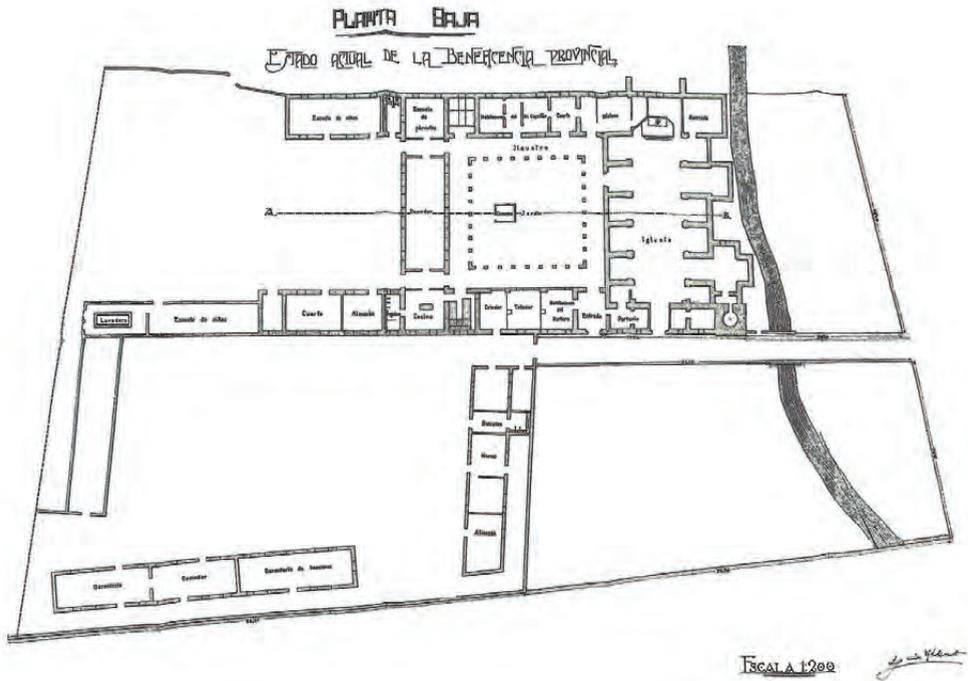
Plano de la Casa de Beneficencia de Castellón en diciembre de 1929. Planta Baja.
